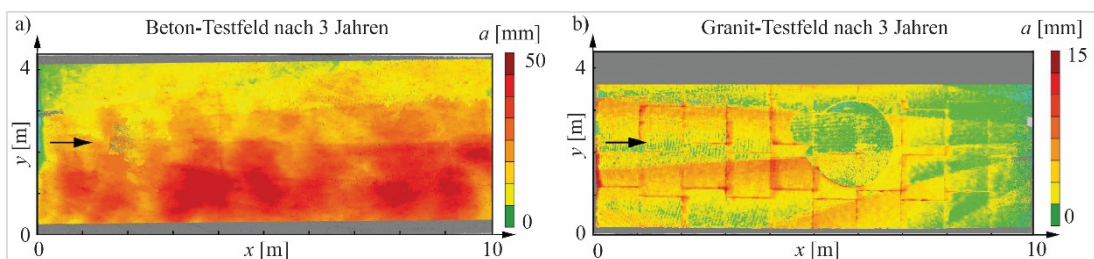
Ermittelte Abrasionstiefen nach drei Betriebsjahren an den Testfeldern aus a) Beton, b) Granit im SBT Pfaffensprung
